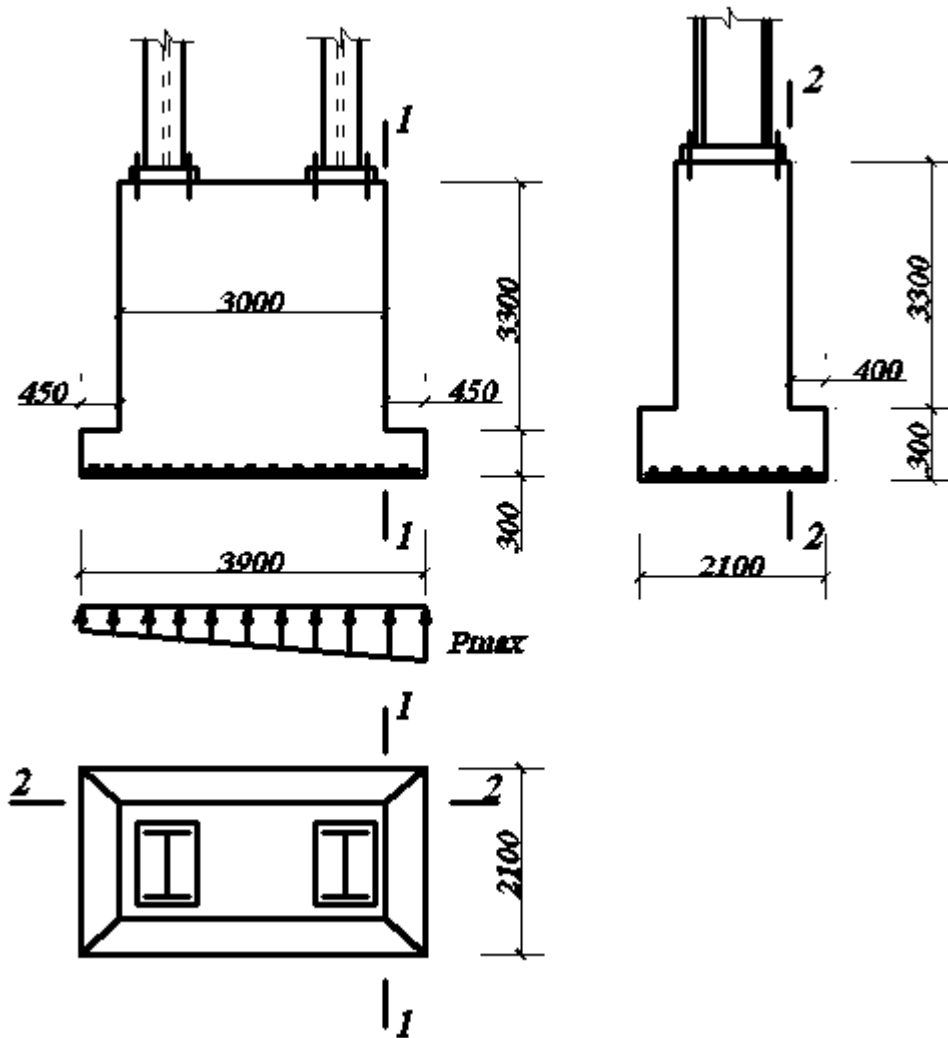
Схеми армування плитної частини фундаменту
